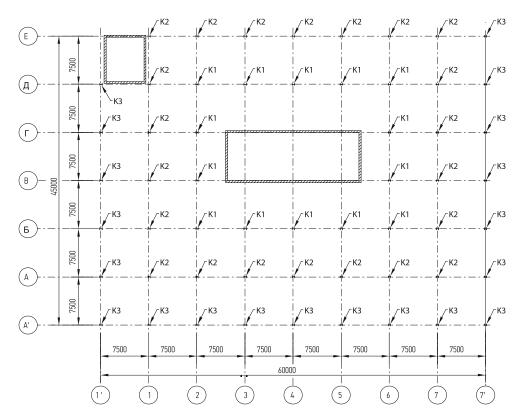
Маркировочный план колонн первого этажа для короткопролетной схемы стального каркаса
